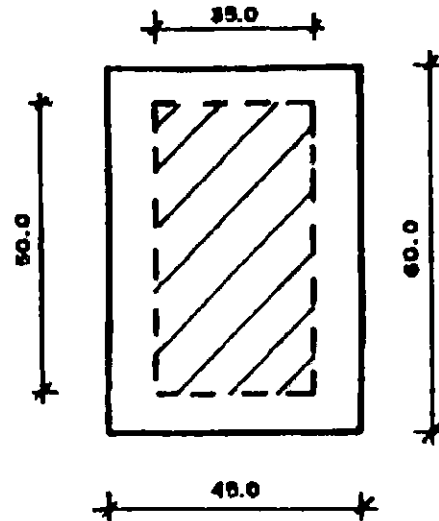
Nueva sección de columna, Primer Entrepiso.
